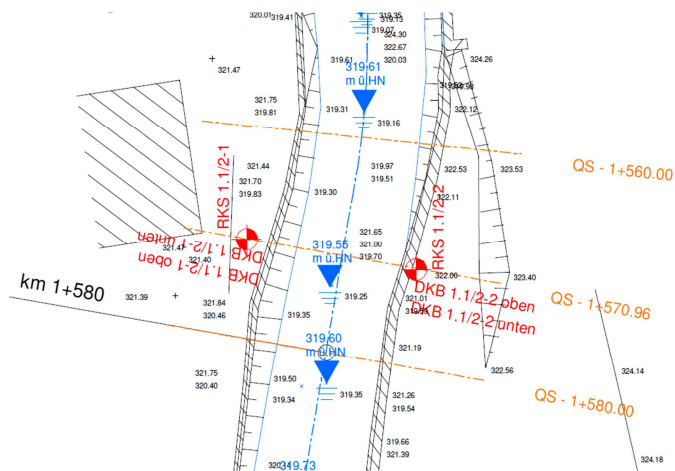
4.5.2: Lageplan Bereich Fluss-km 1+580
